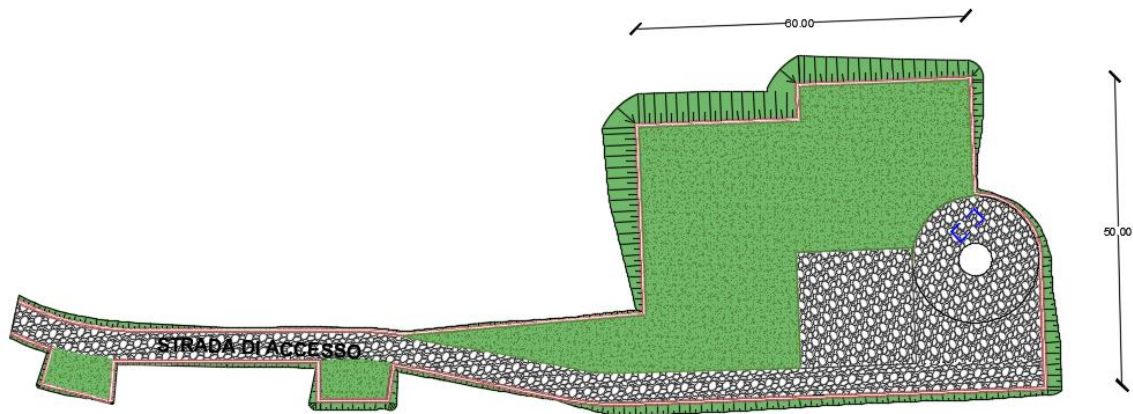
Planimetria piazzola tipo in fase di esercizio
